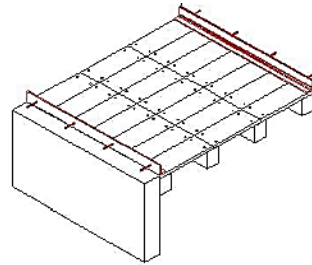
Representação esquemática da ligação pavimento/parede através de cantoneira (adaptado de Doglioni, 2000)
